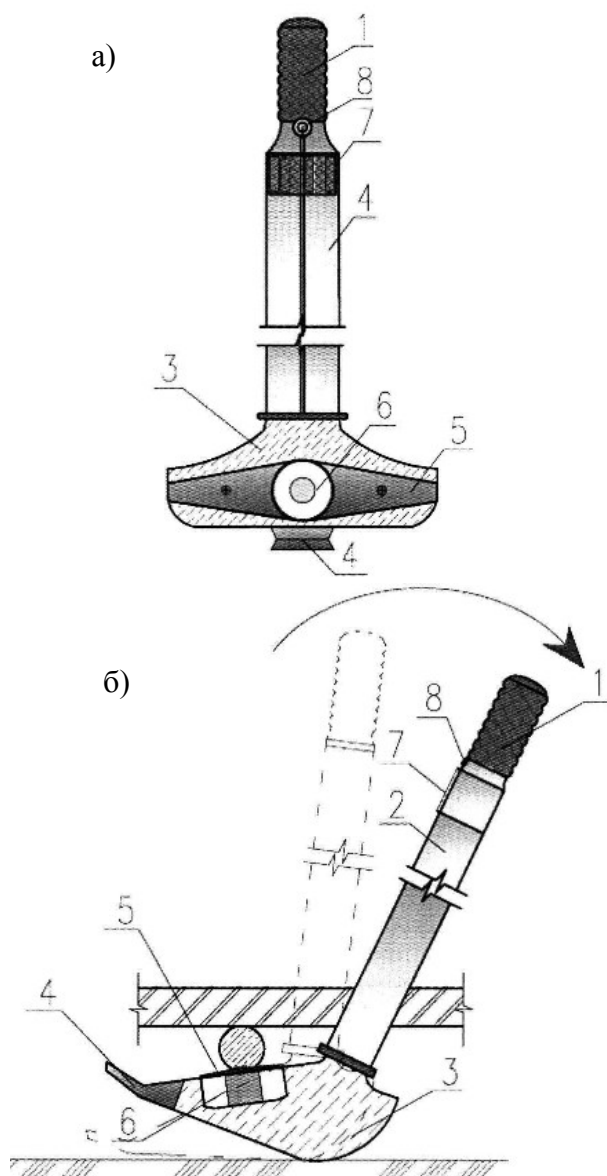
Усовершенствованное устройство-инструмент для позиционирования арматурных стержней: а – вид спереди; б – вид сбоку
